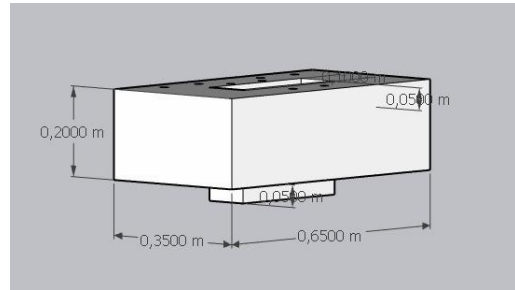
Pondasi Knock Down Tipe 1 (male)
